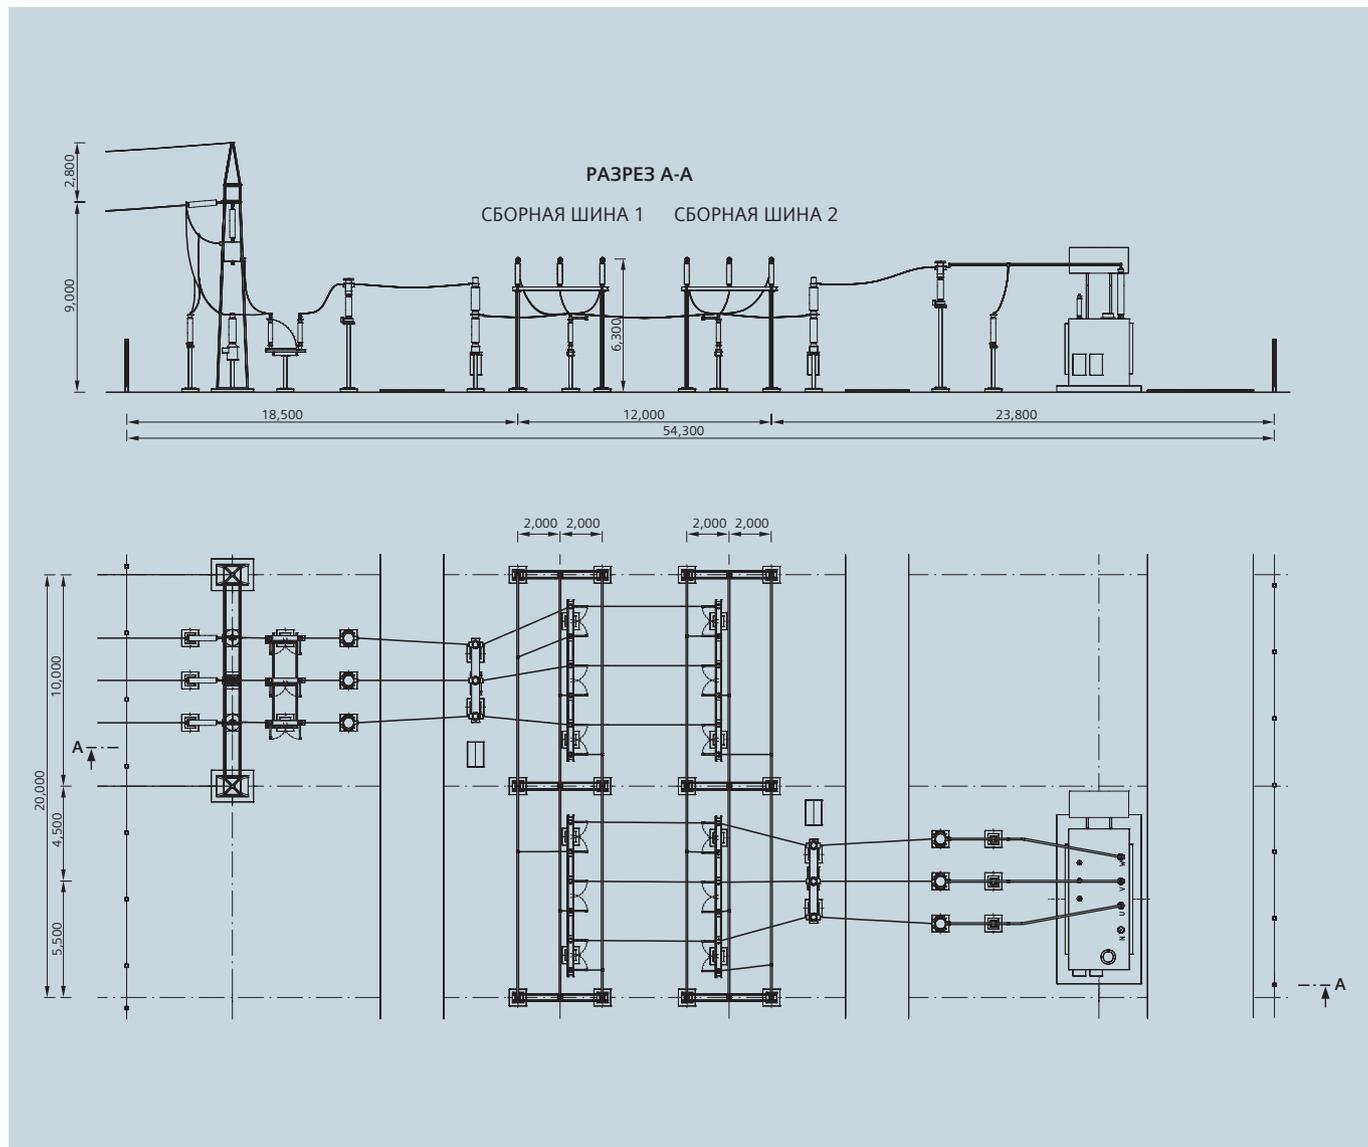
Продольное расположение оборудования, РУ 110 кВ
